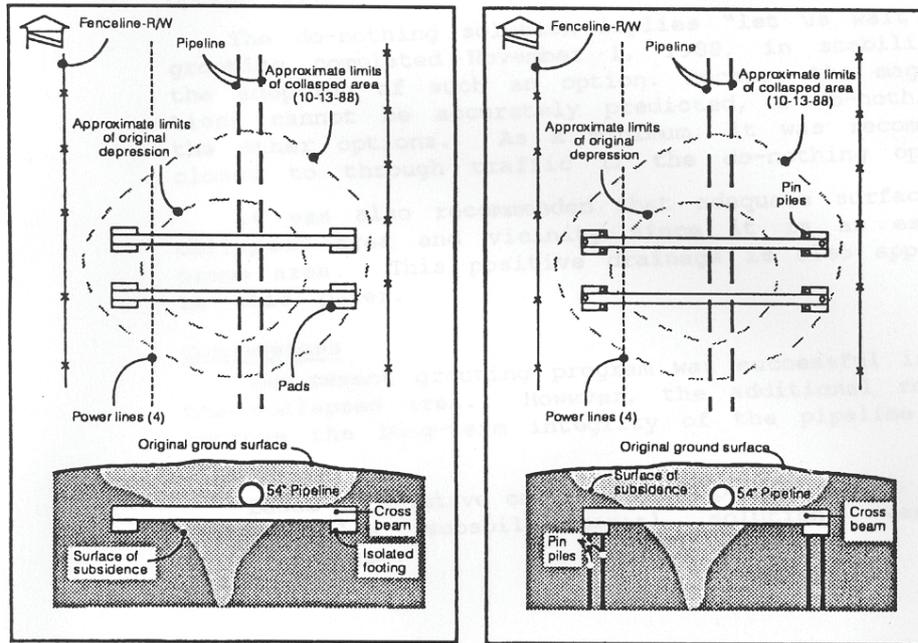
(a et b) : Illustration de l'enjambement d'un fontis par des poutres pour supporter un pipeline préexistant.
